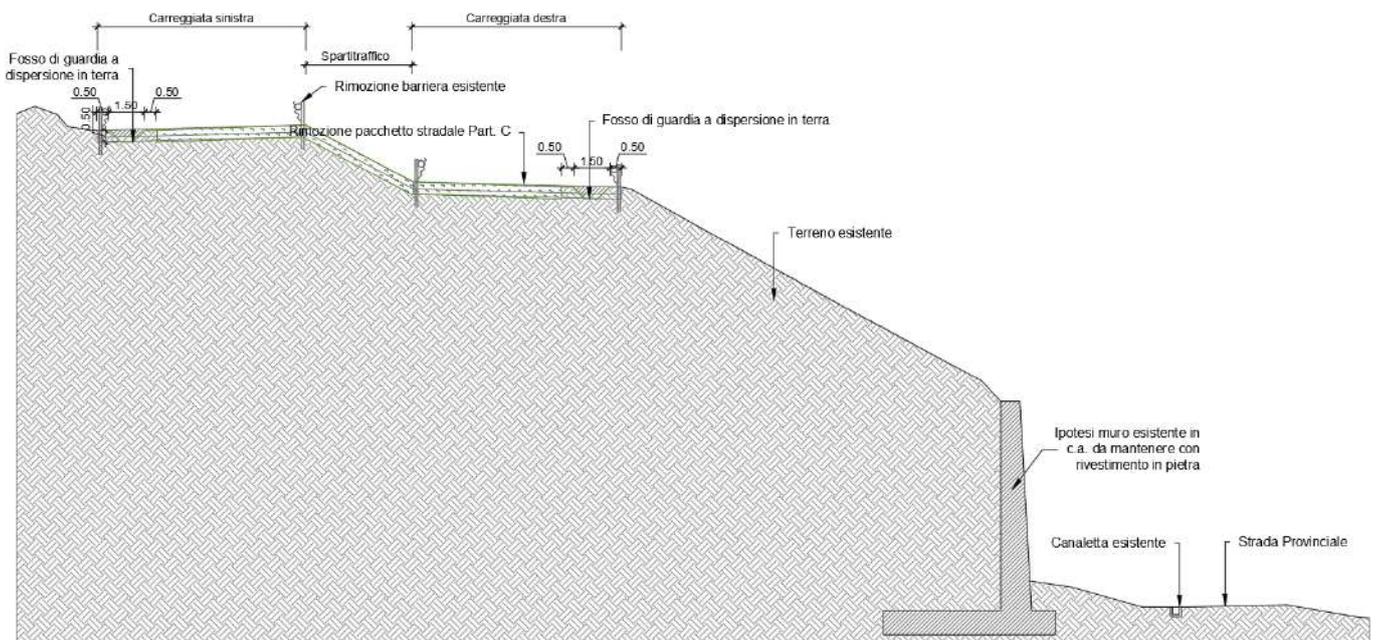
Sezione tipo D_3 mezza costa sfalsata con muro di sottoscarpa da mantenere
